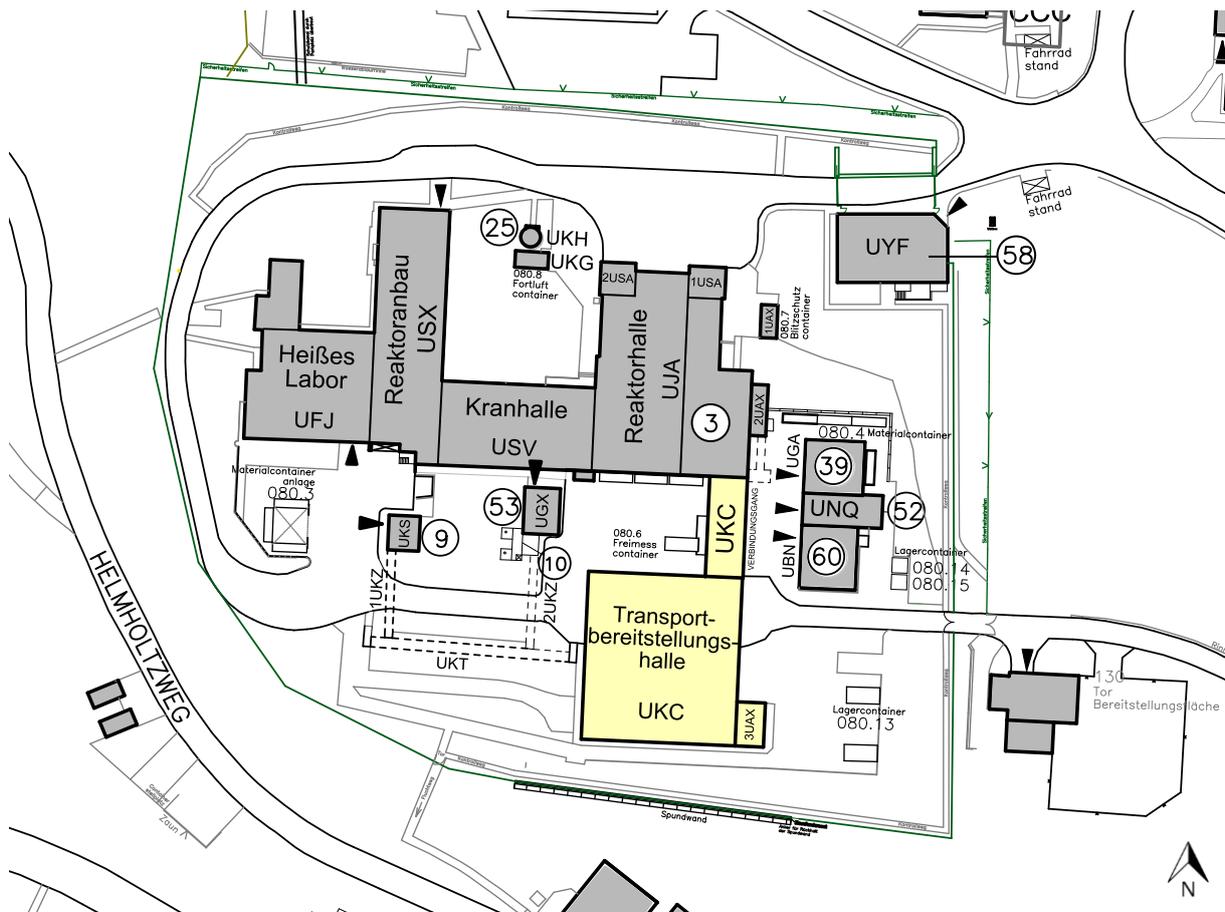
Lageplan Gebäude und Anlagenbereiche der FRG und des HL
